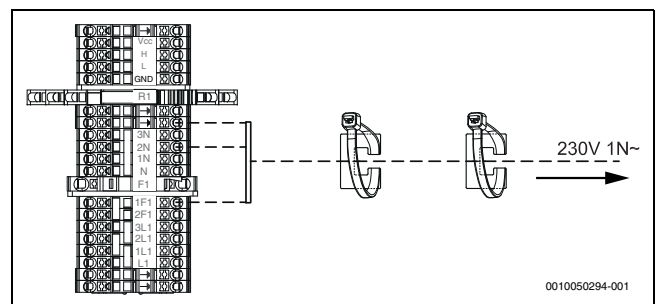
Raccordement des câbles de chauffage (accessoire)
